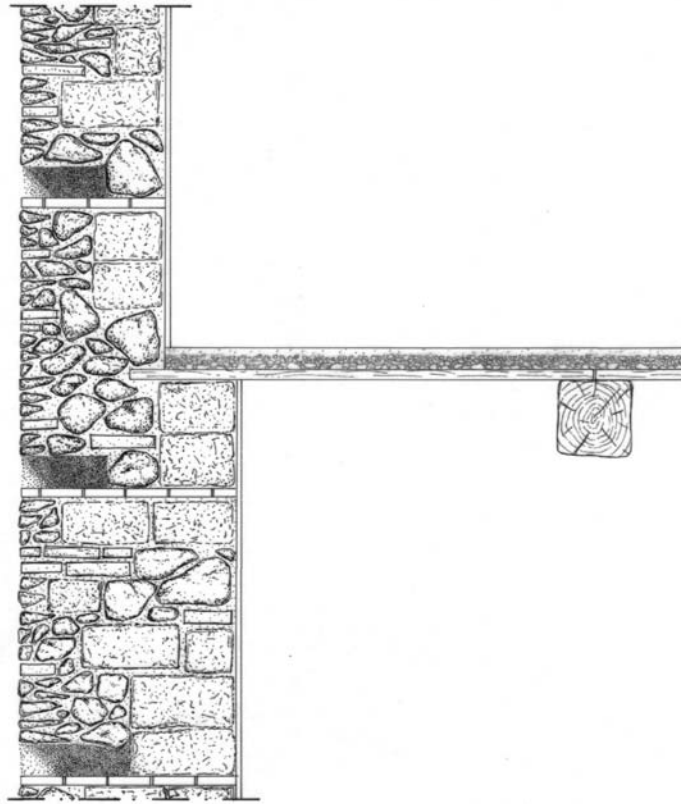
Section - Wall thinning and "Civatura" (credits: author).
